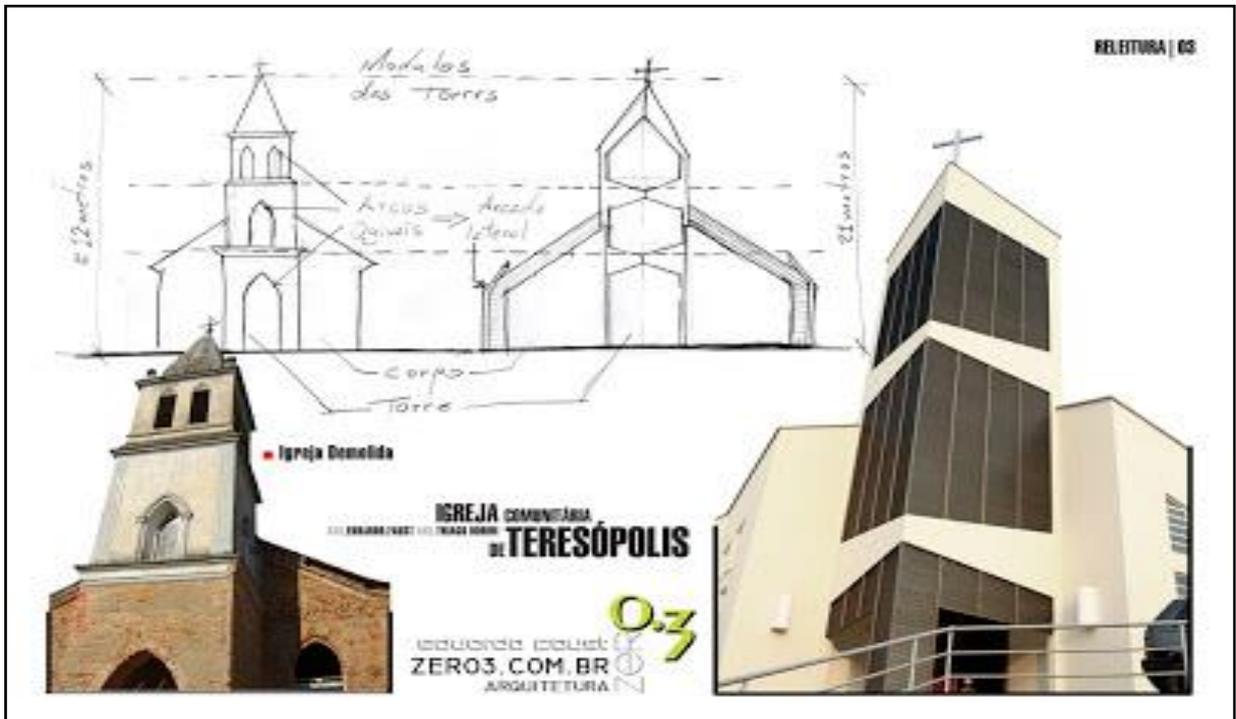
Croquis das fachadas antiga e atual da Igreja de Santa Teresa D'Ávila
